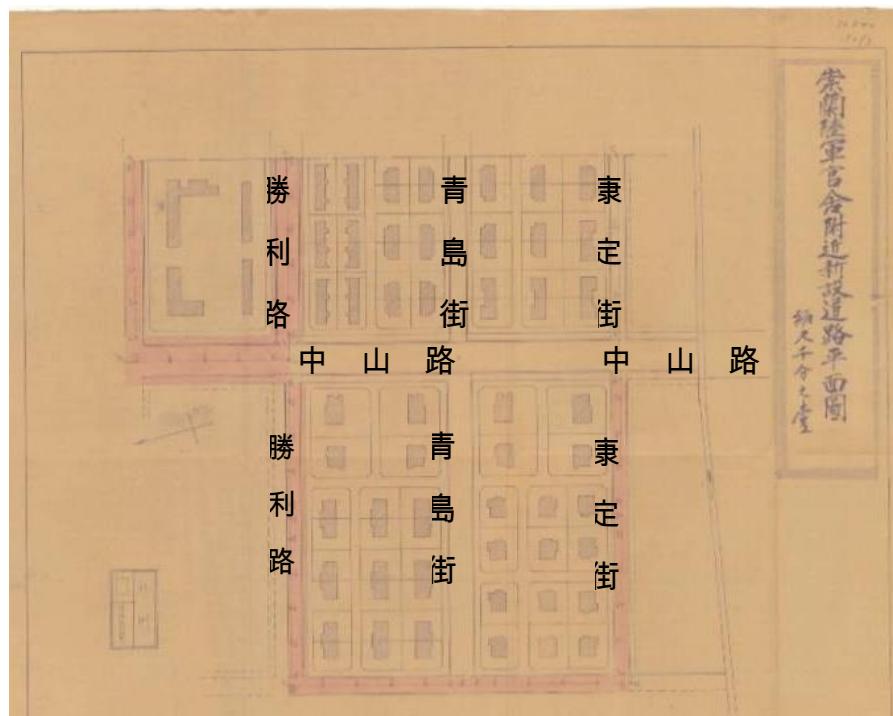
崇蘭陸軍官舍附近新設道路平面圖
